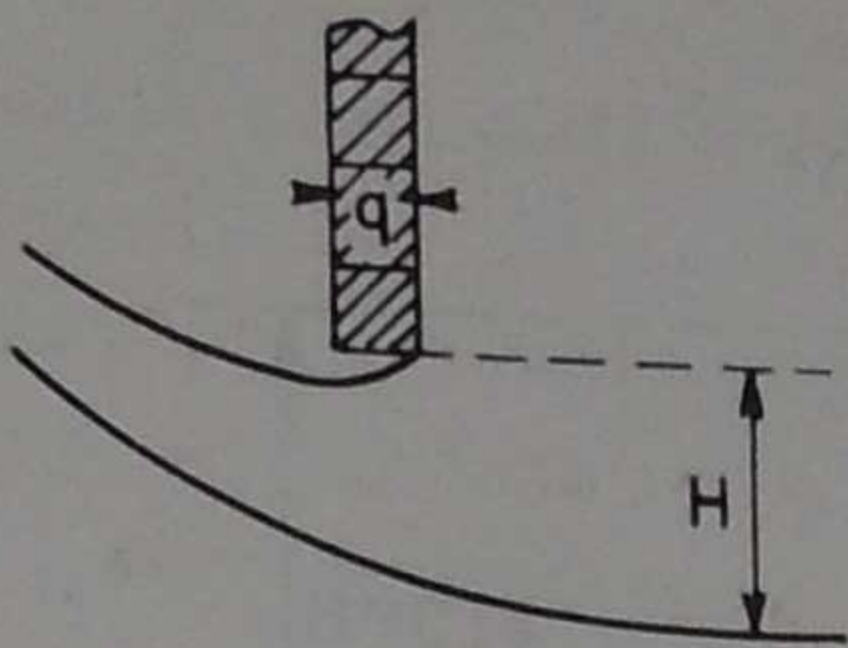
Barrage-déversoir à poutrelles
